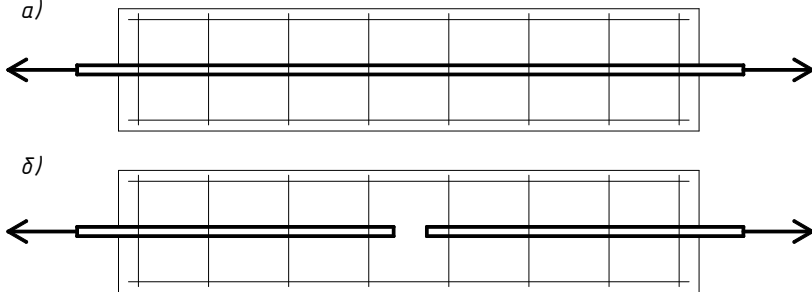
Основні схеми дослідження зчеплення арматури з бетоном в залізобетонних елементах і конструкціях
